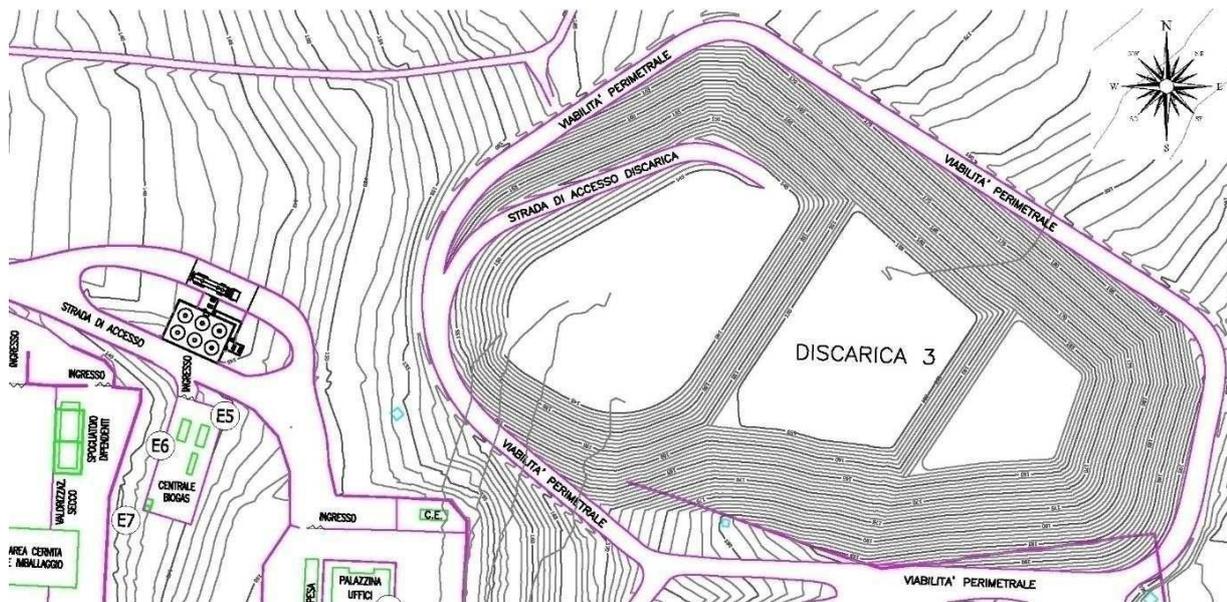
planimetria impianto complesso CIVETA con posizionamento della discarica attualmente in esercizio
